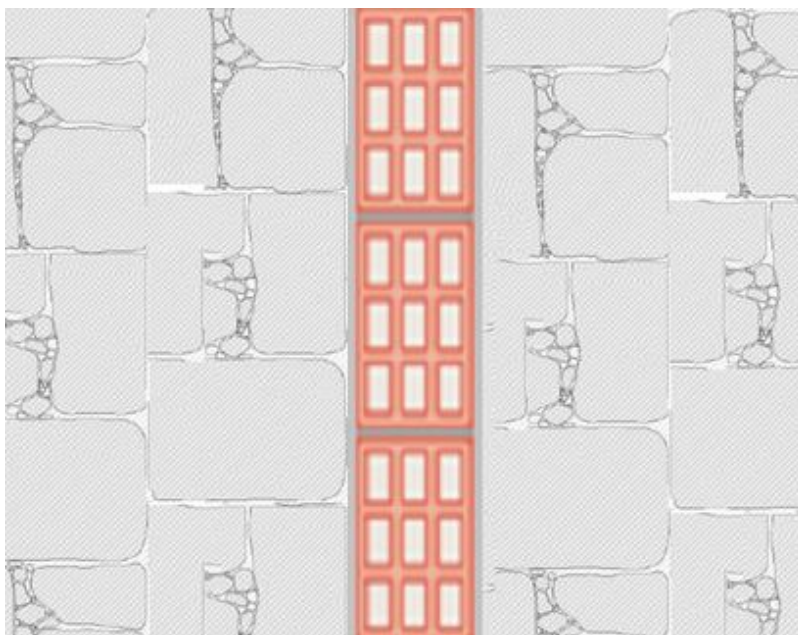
Corte pormenorizado da solução tradicional de alvenaria de tijolo (Autoria própria)
